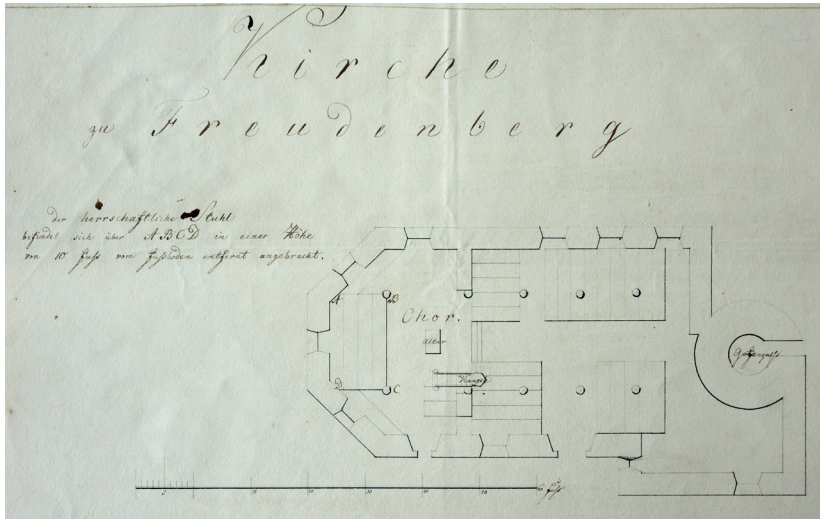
Den ältesten erhaltenen Grundriss zeichnete Bauführer Niermann 1828 zur Taxierung der Fürstenloge im Chor; Norden ist unten.
